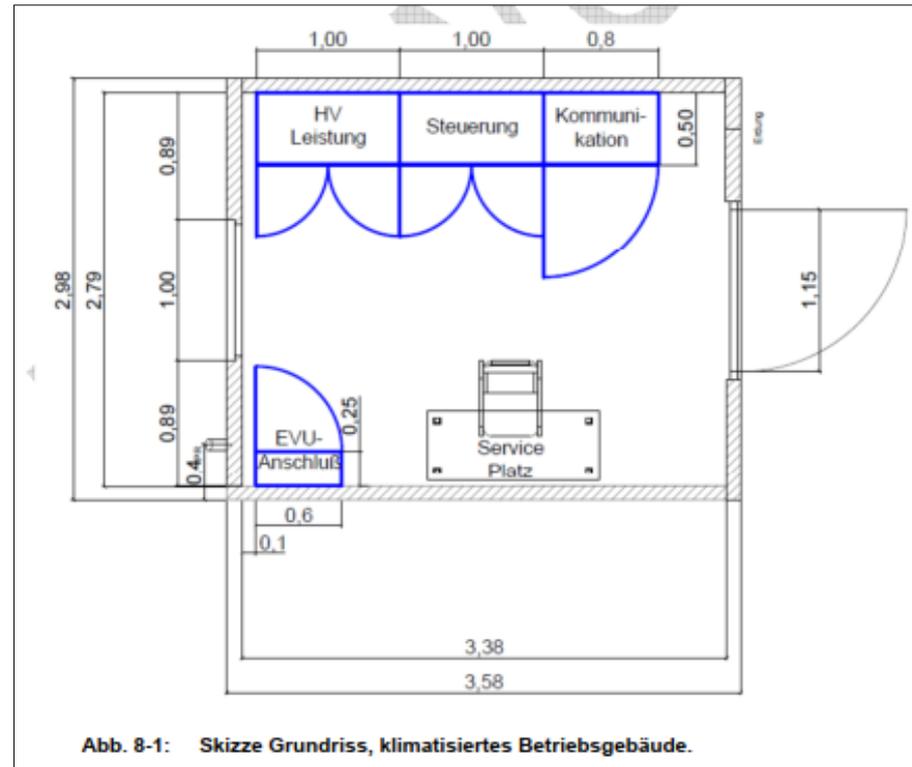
Skizze Grundriss, klimatisiertes Betriebsgebäude.
